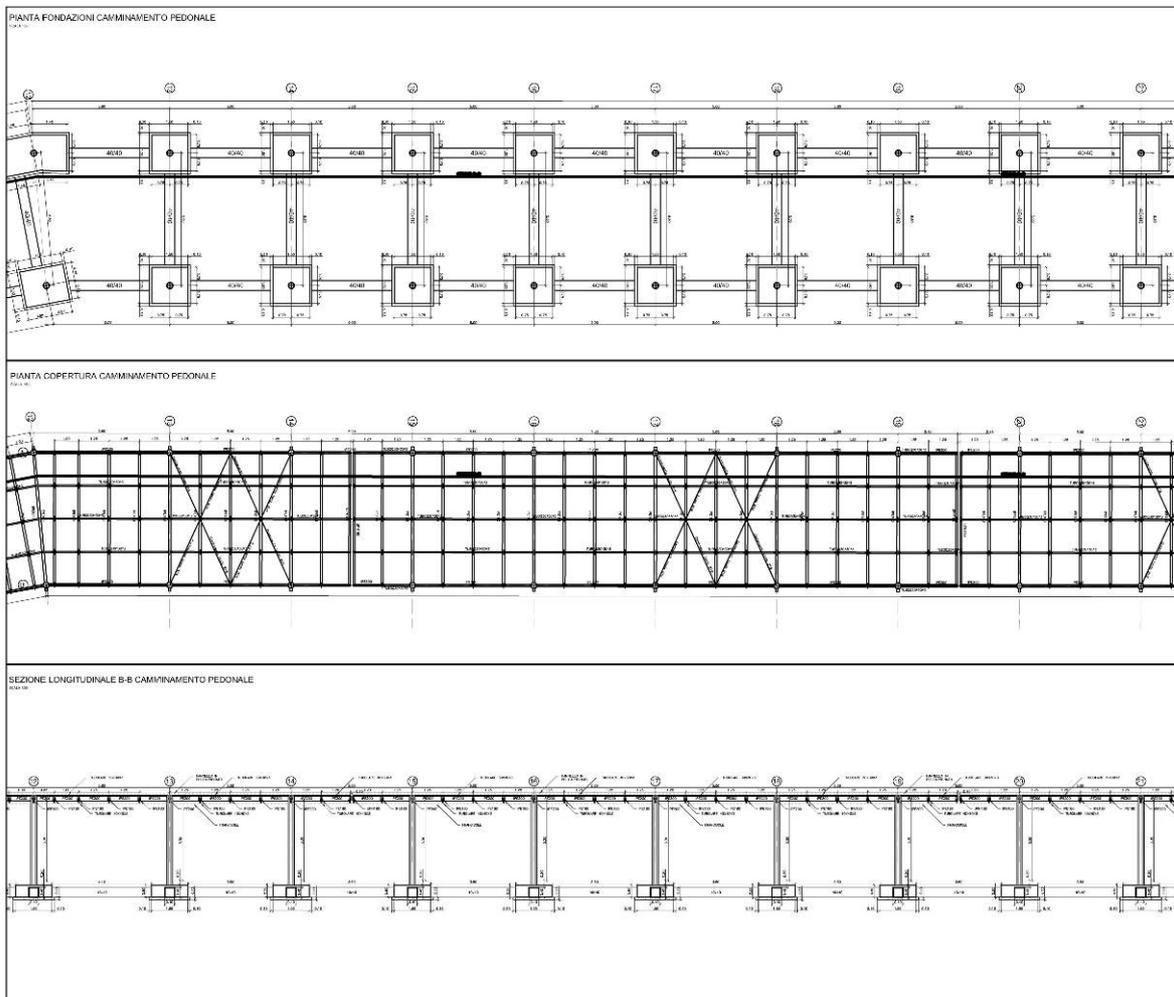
Pianta fondazioni, copertura e sezione longitudinale del camminamento pedonale
